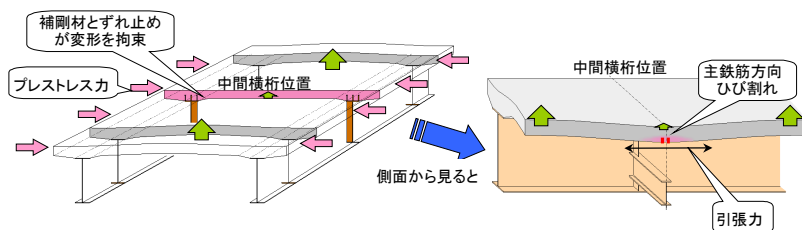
中間横桁位置の主鉄筋方向ひび割れ
